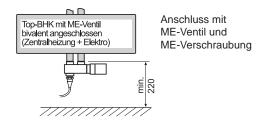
Einbau in Badheizkörper ohne M-Anschluss bzw. Verwendung der äußeren unteren Anschlüsse trotz M-Anschluss/50 mm Anschluss.
